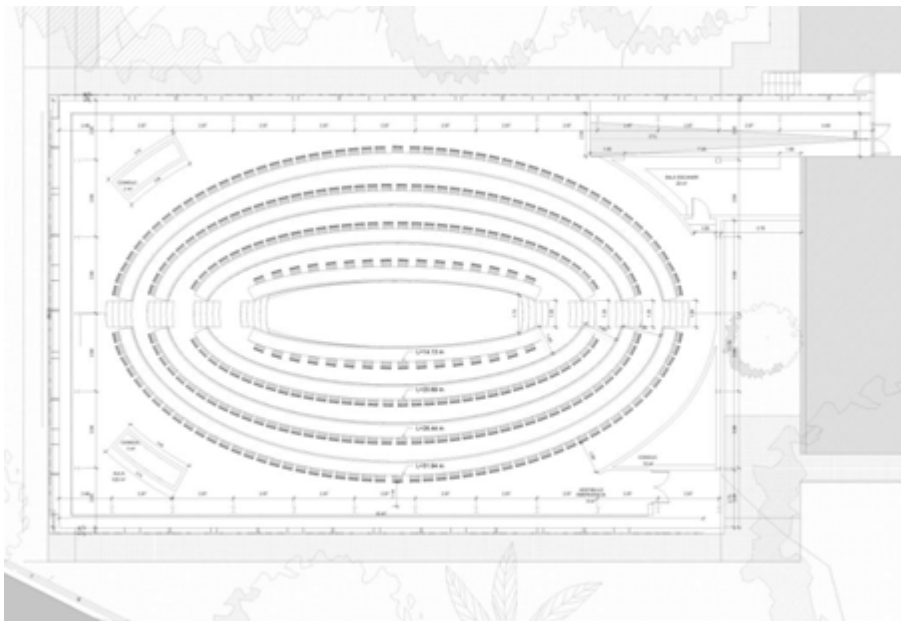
plano de planta. Fuente: Fiab S.L.
